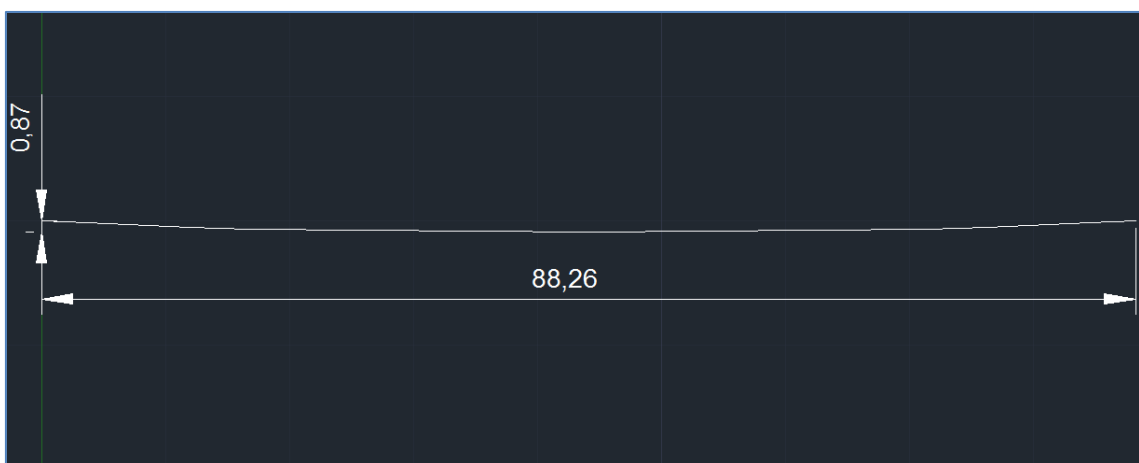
Detalle de la sección transversal del cauce natural elaborado en Autocad
